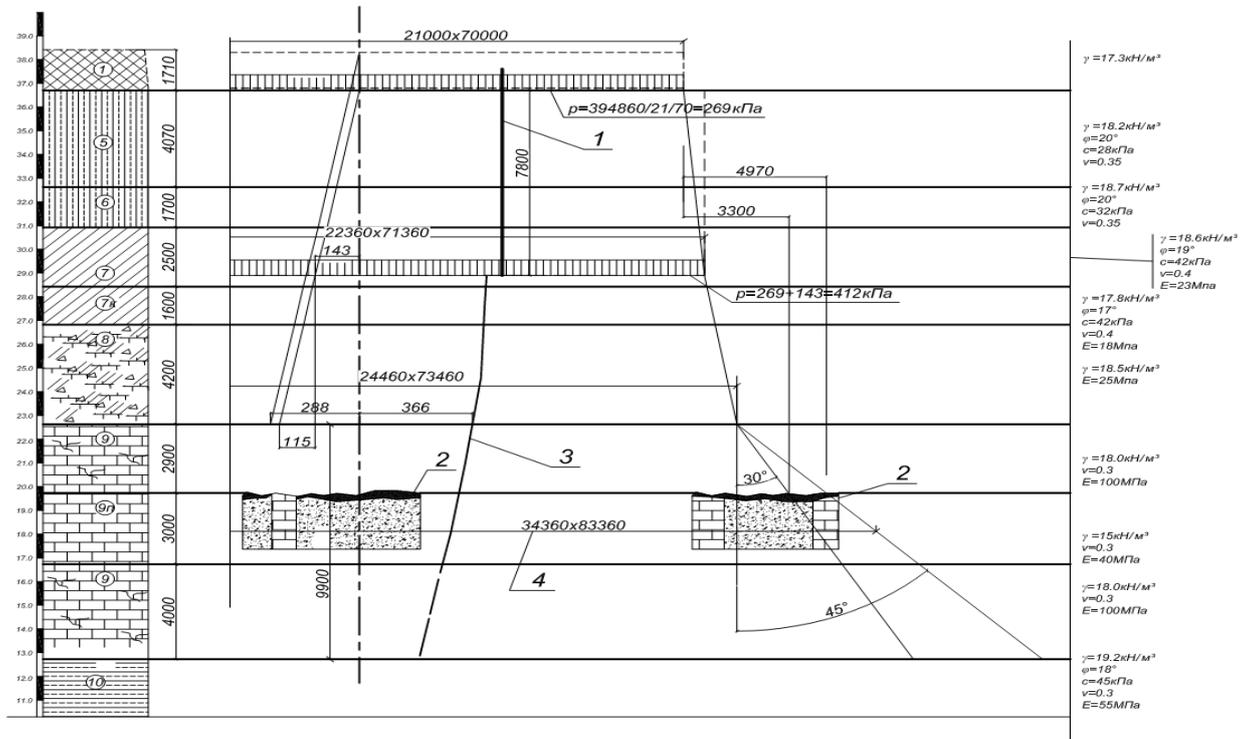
Схема к расчету основания свайных фундаментов из призматических свай. 1 – призматическая свая; 2 – горные выработки (катакомбы); эпюра дополнительного давления; 4 – размер средней линии граней пирамиды продавливания
